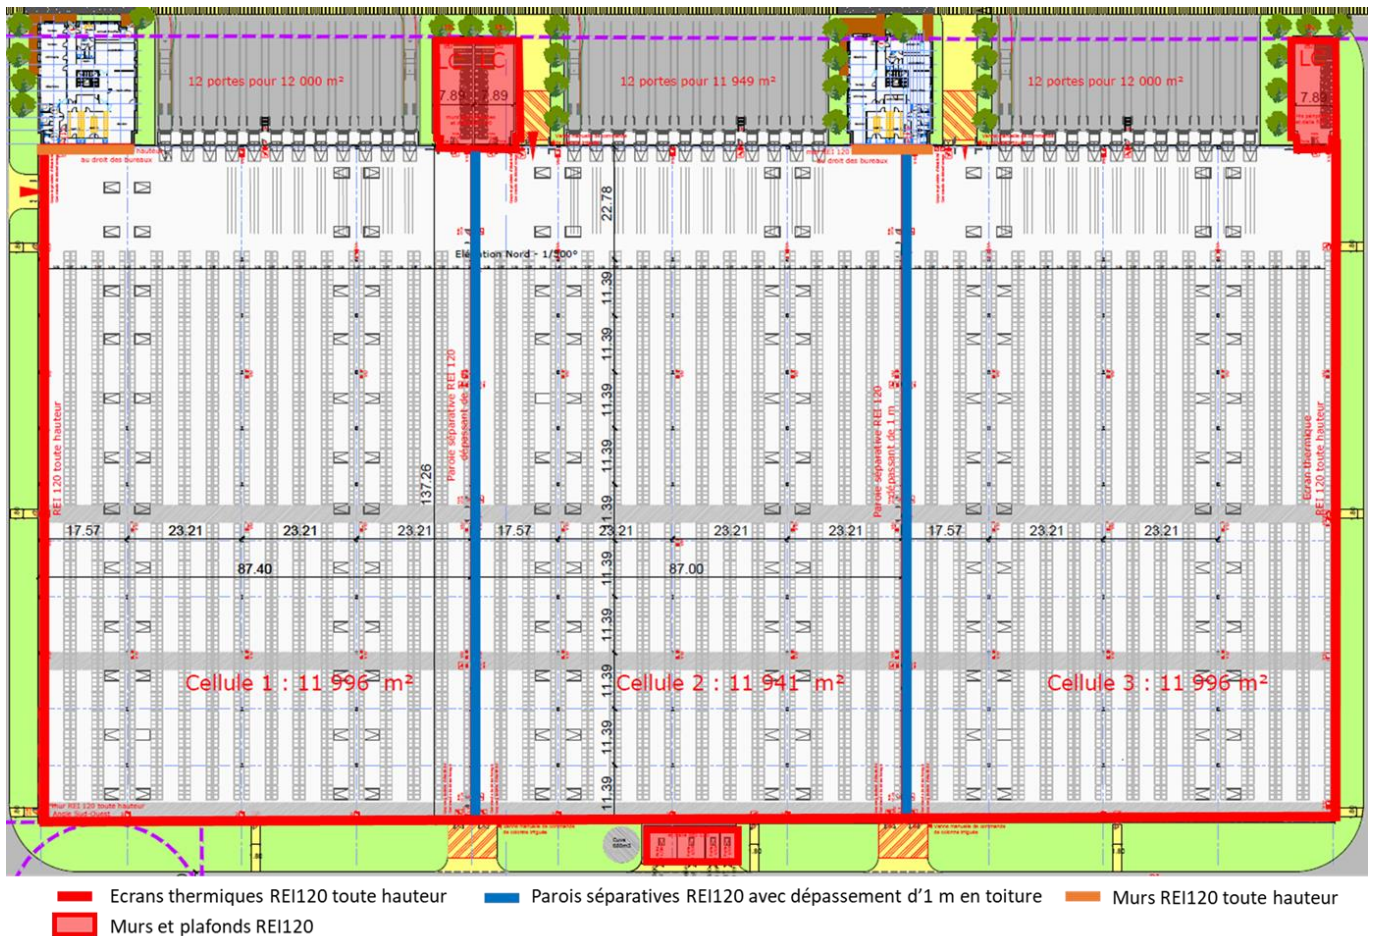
Plan des murs coupe-feu (source : dossier de demande d'enregistrement)
